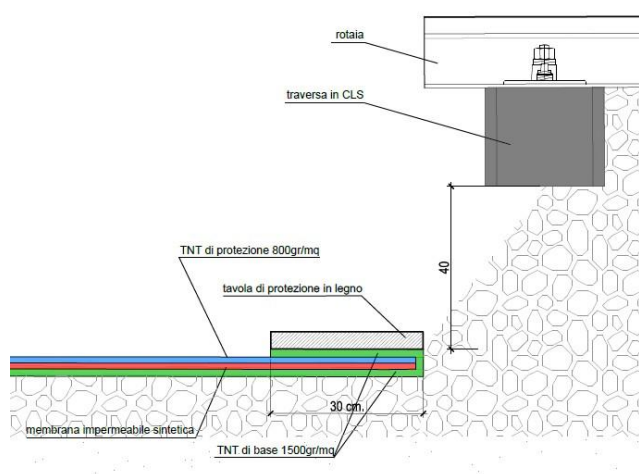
a - Protezione della giunzione trasversale
